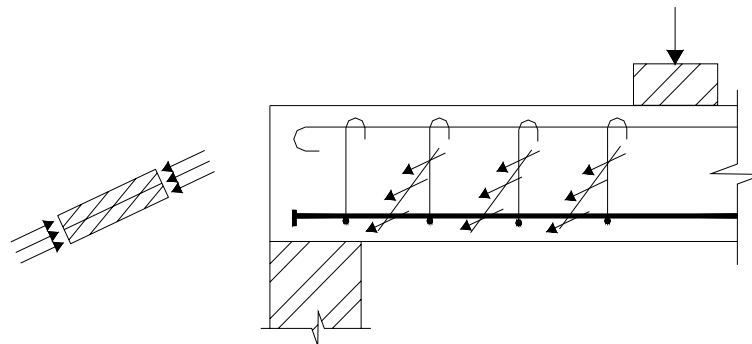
Tensões de compressão atravessando as fissuras (FUSCO, 1995)
